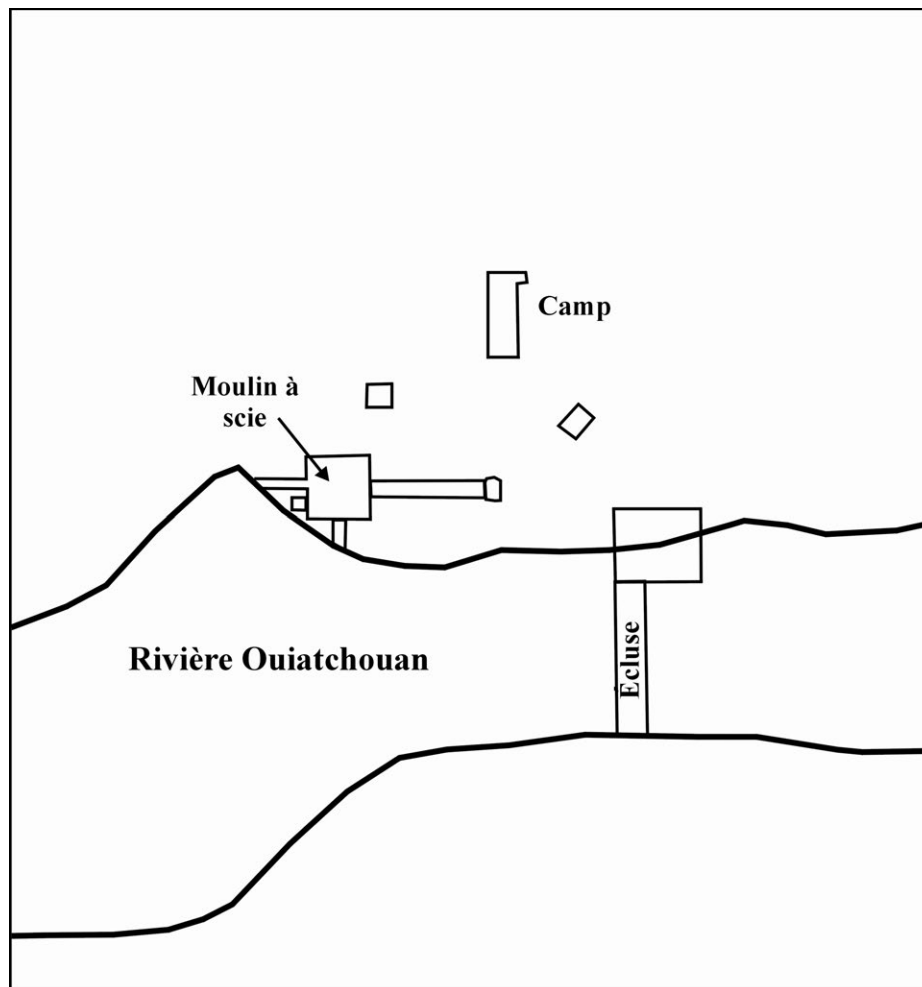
extrait du plan de la figure 21. Plan des installations de la chute Maligne, 1921.
